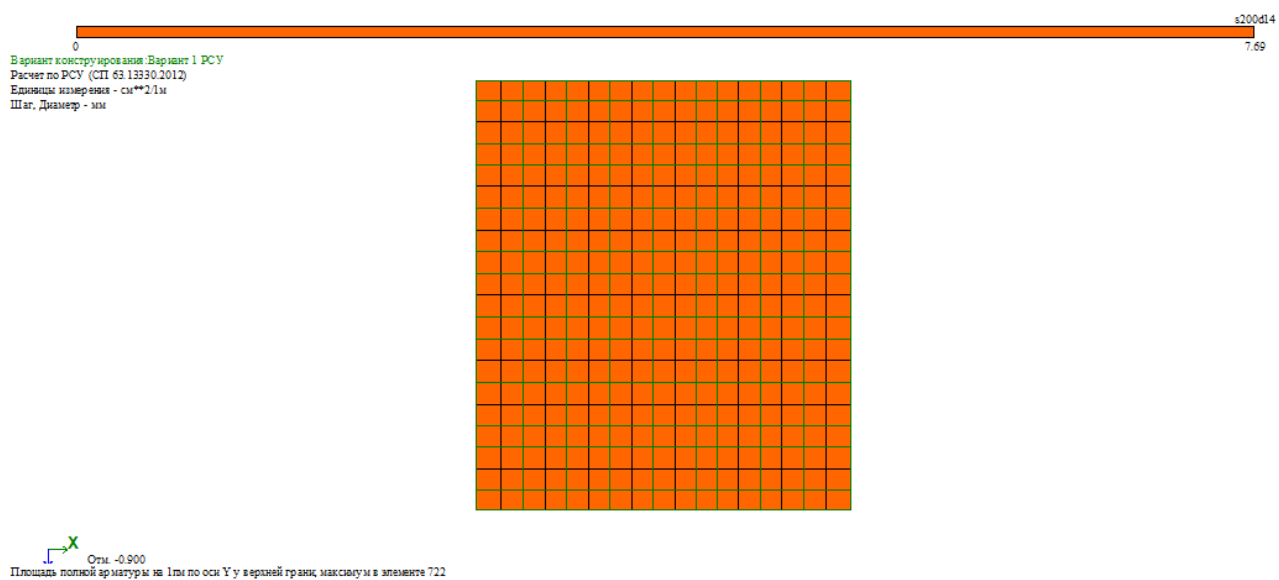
По оси Y верхней грани – площадь полной арматуры 1 п.м.
